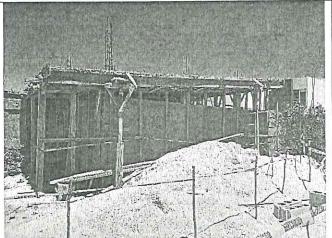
Vista de la obra inmobiliaria "privado con techo a desnivel y en la parte elevada entrada de aire.
